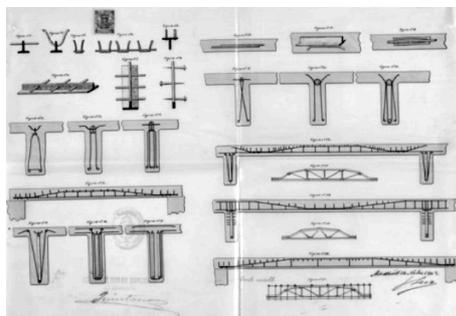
M. Jalvo: patente de estructuras horizontales de hormigón armado, Madrid 1903.
